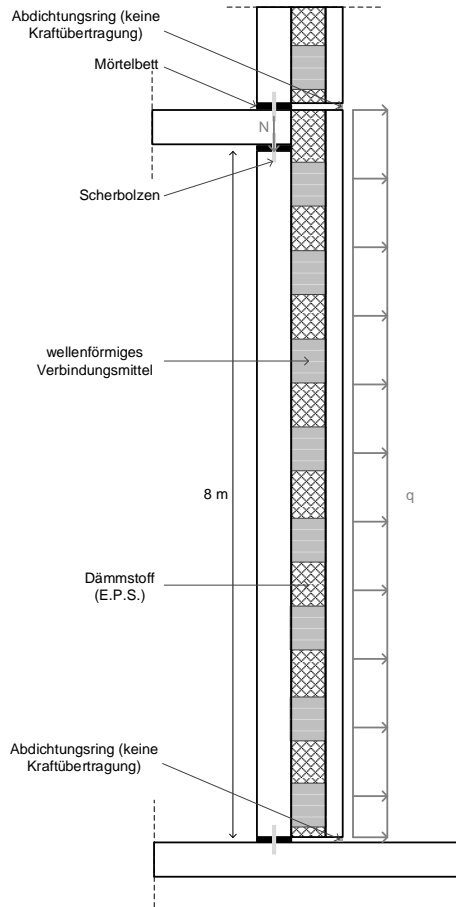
Sandwichwand im Erdgeschoss eines Hotelgebäudes (maßstabsverzerrte Darstellung)
